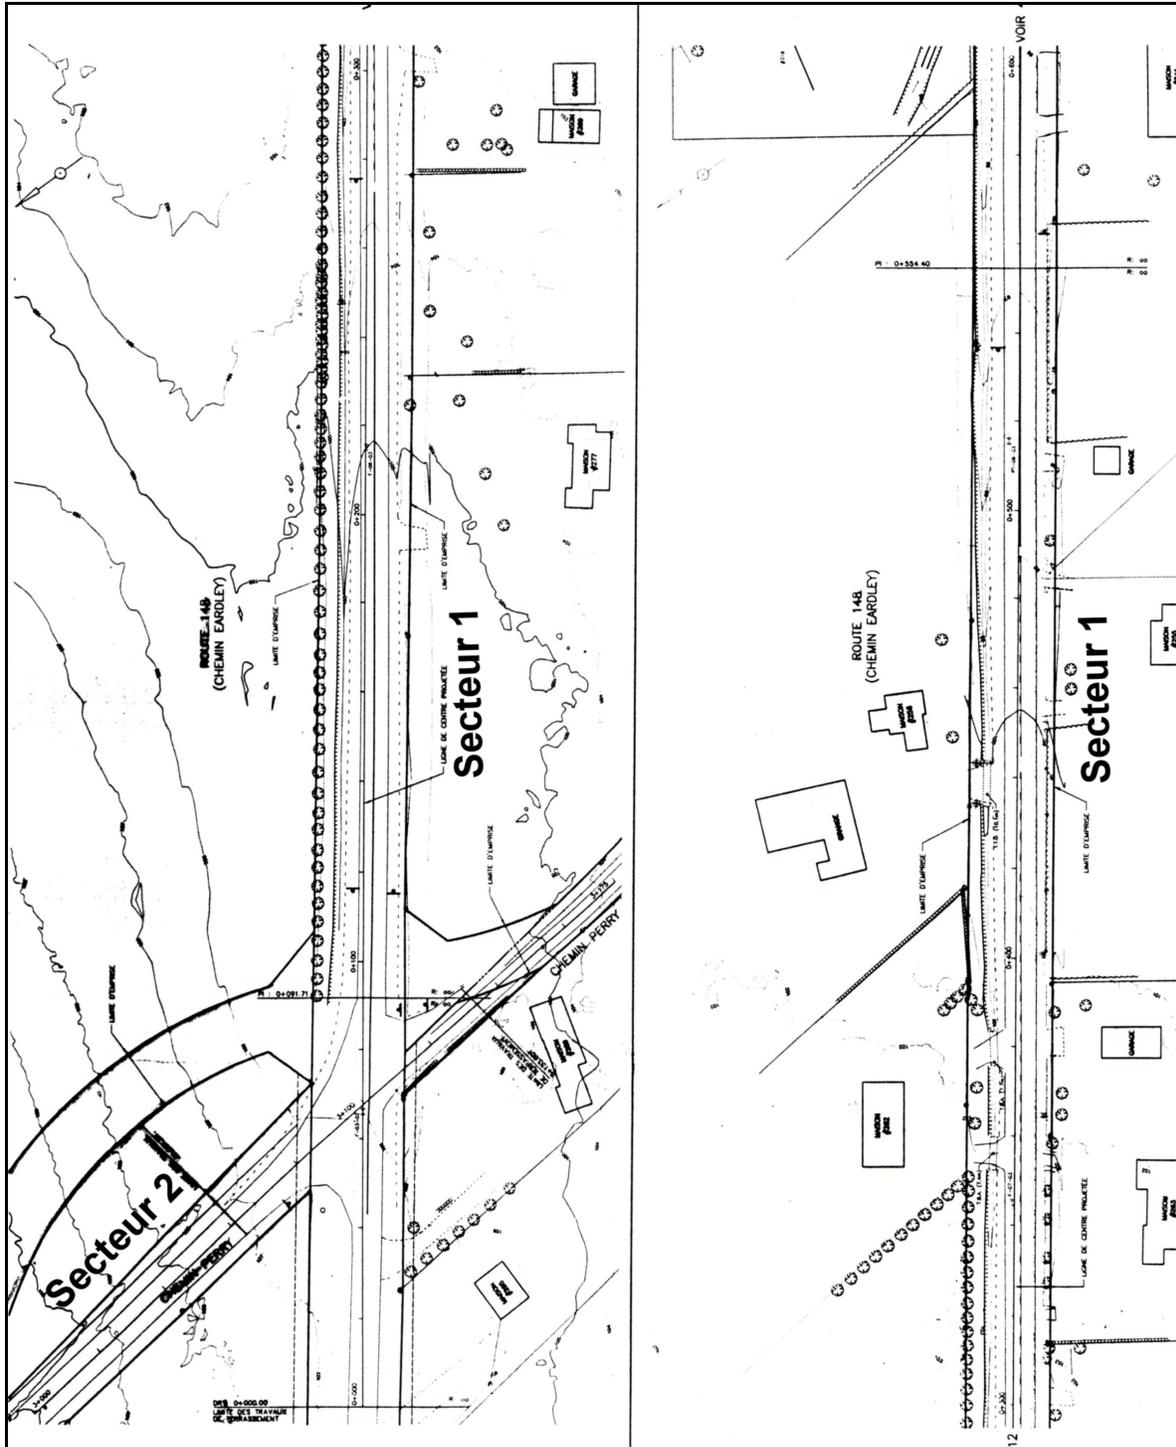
Localisation des secteurs d'inventaire sur le plan de construction du projet 20-6672-8479, route 148 (1/2)
